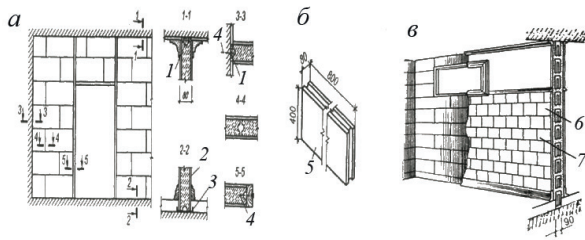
Перегородки з гіпсових і легкобетонних плит:
